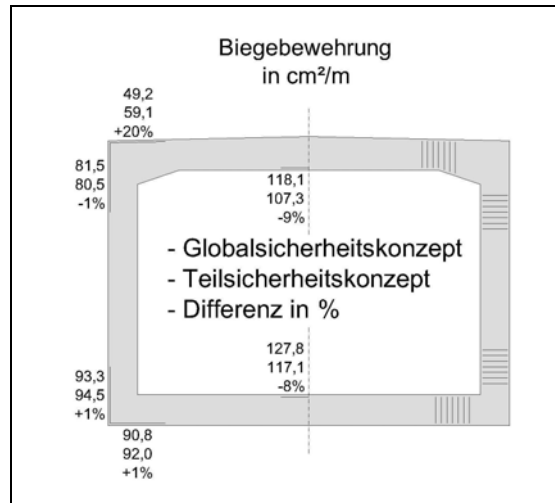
Tunnel in offener Bauweise, Bewehrung aus Nachweisen im Grenzzustand 2
